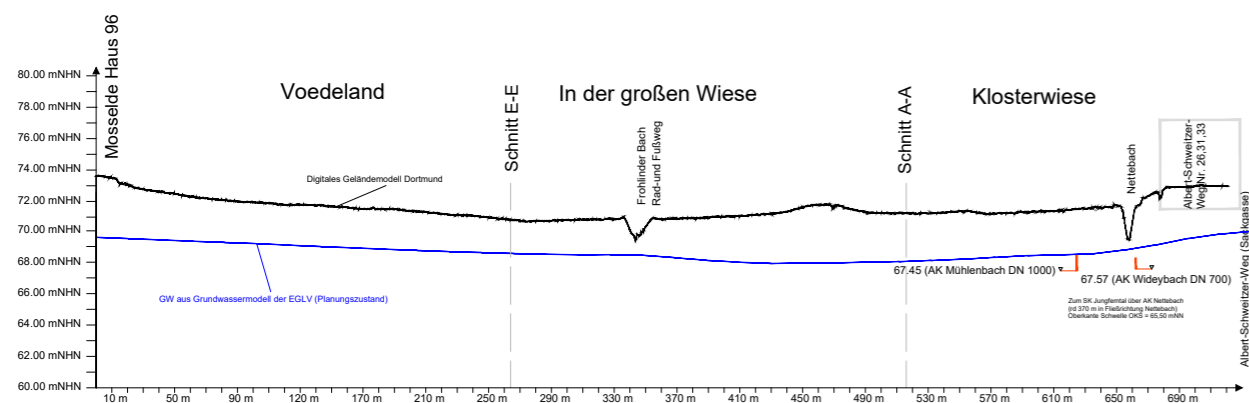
Geländeschnitt C-C mit Grundwasserhorizont (blaue Linie)
